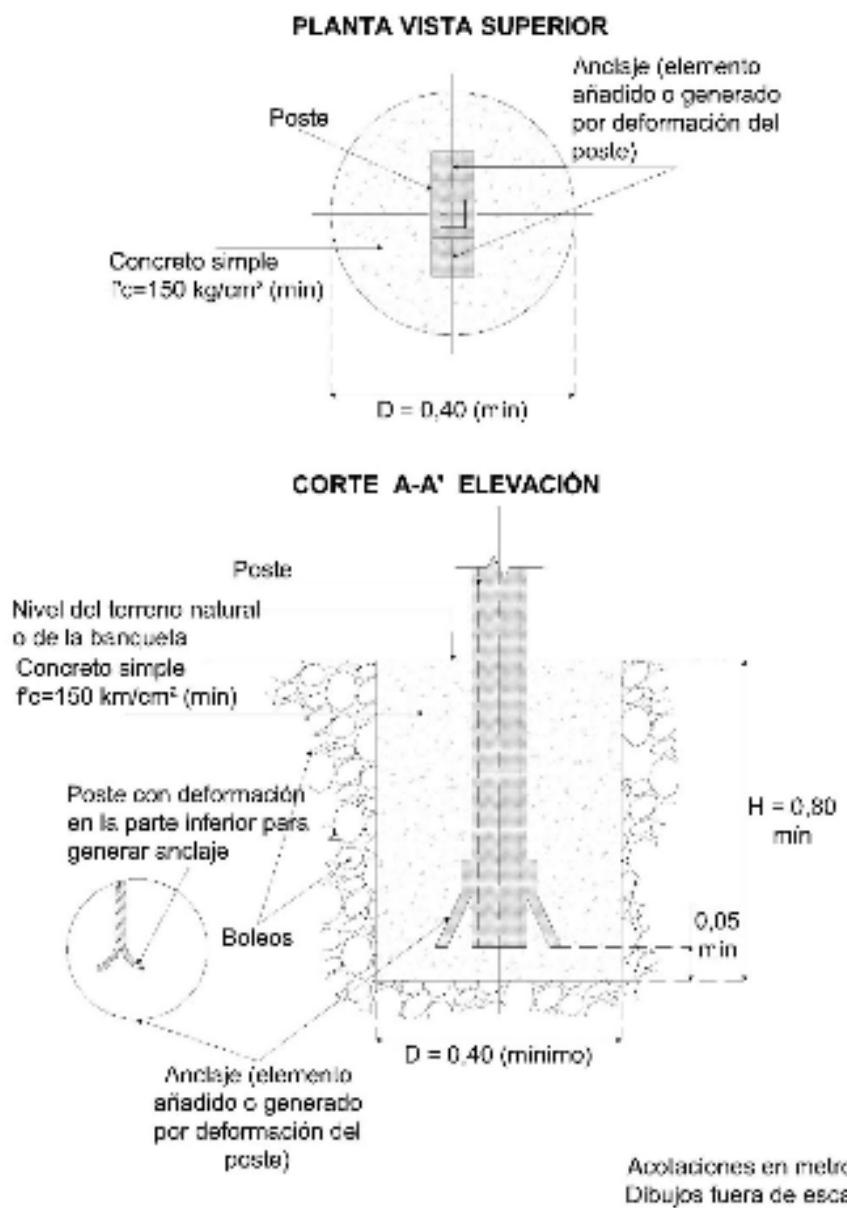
3 Cimentación tipo para los postes de las señales bajas
